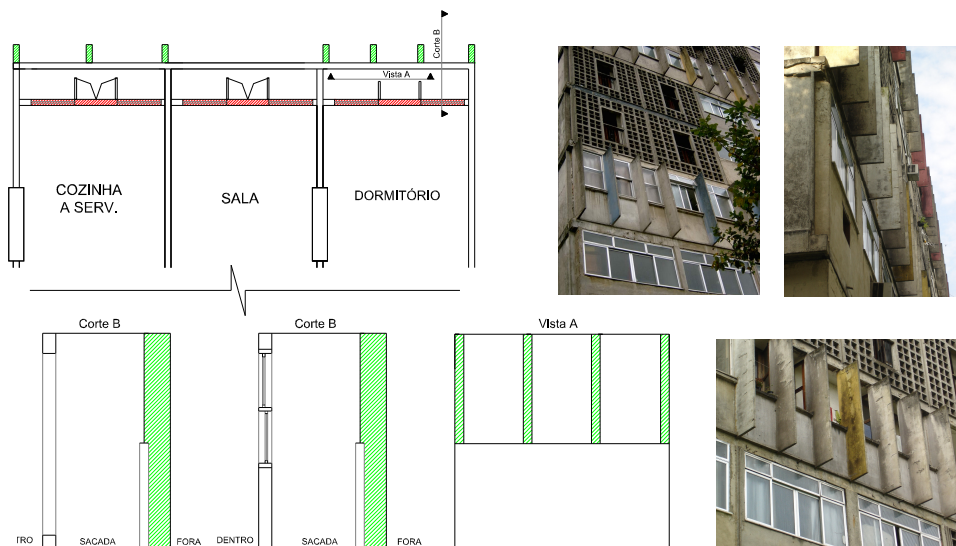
, 38 e 39: Planta e Corte dos brises – Pavimentos de circulação
